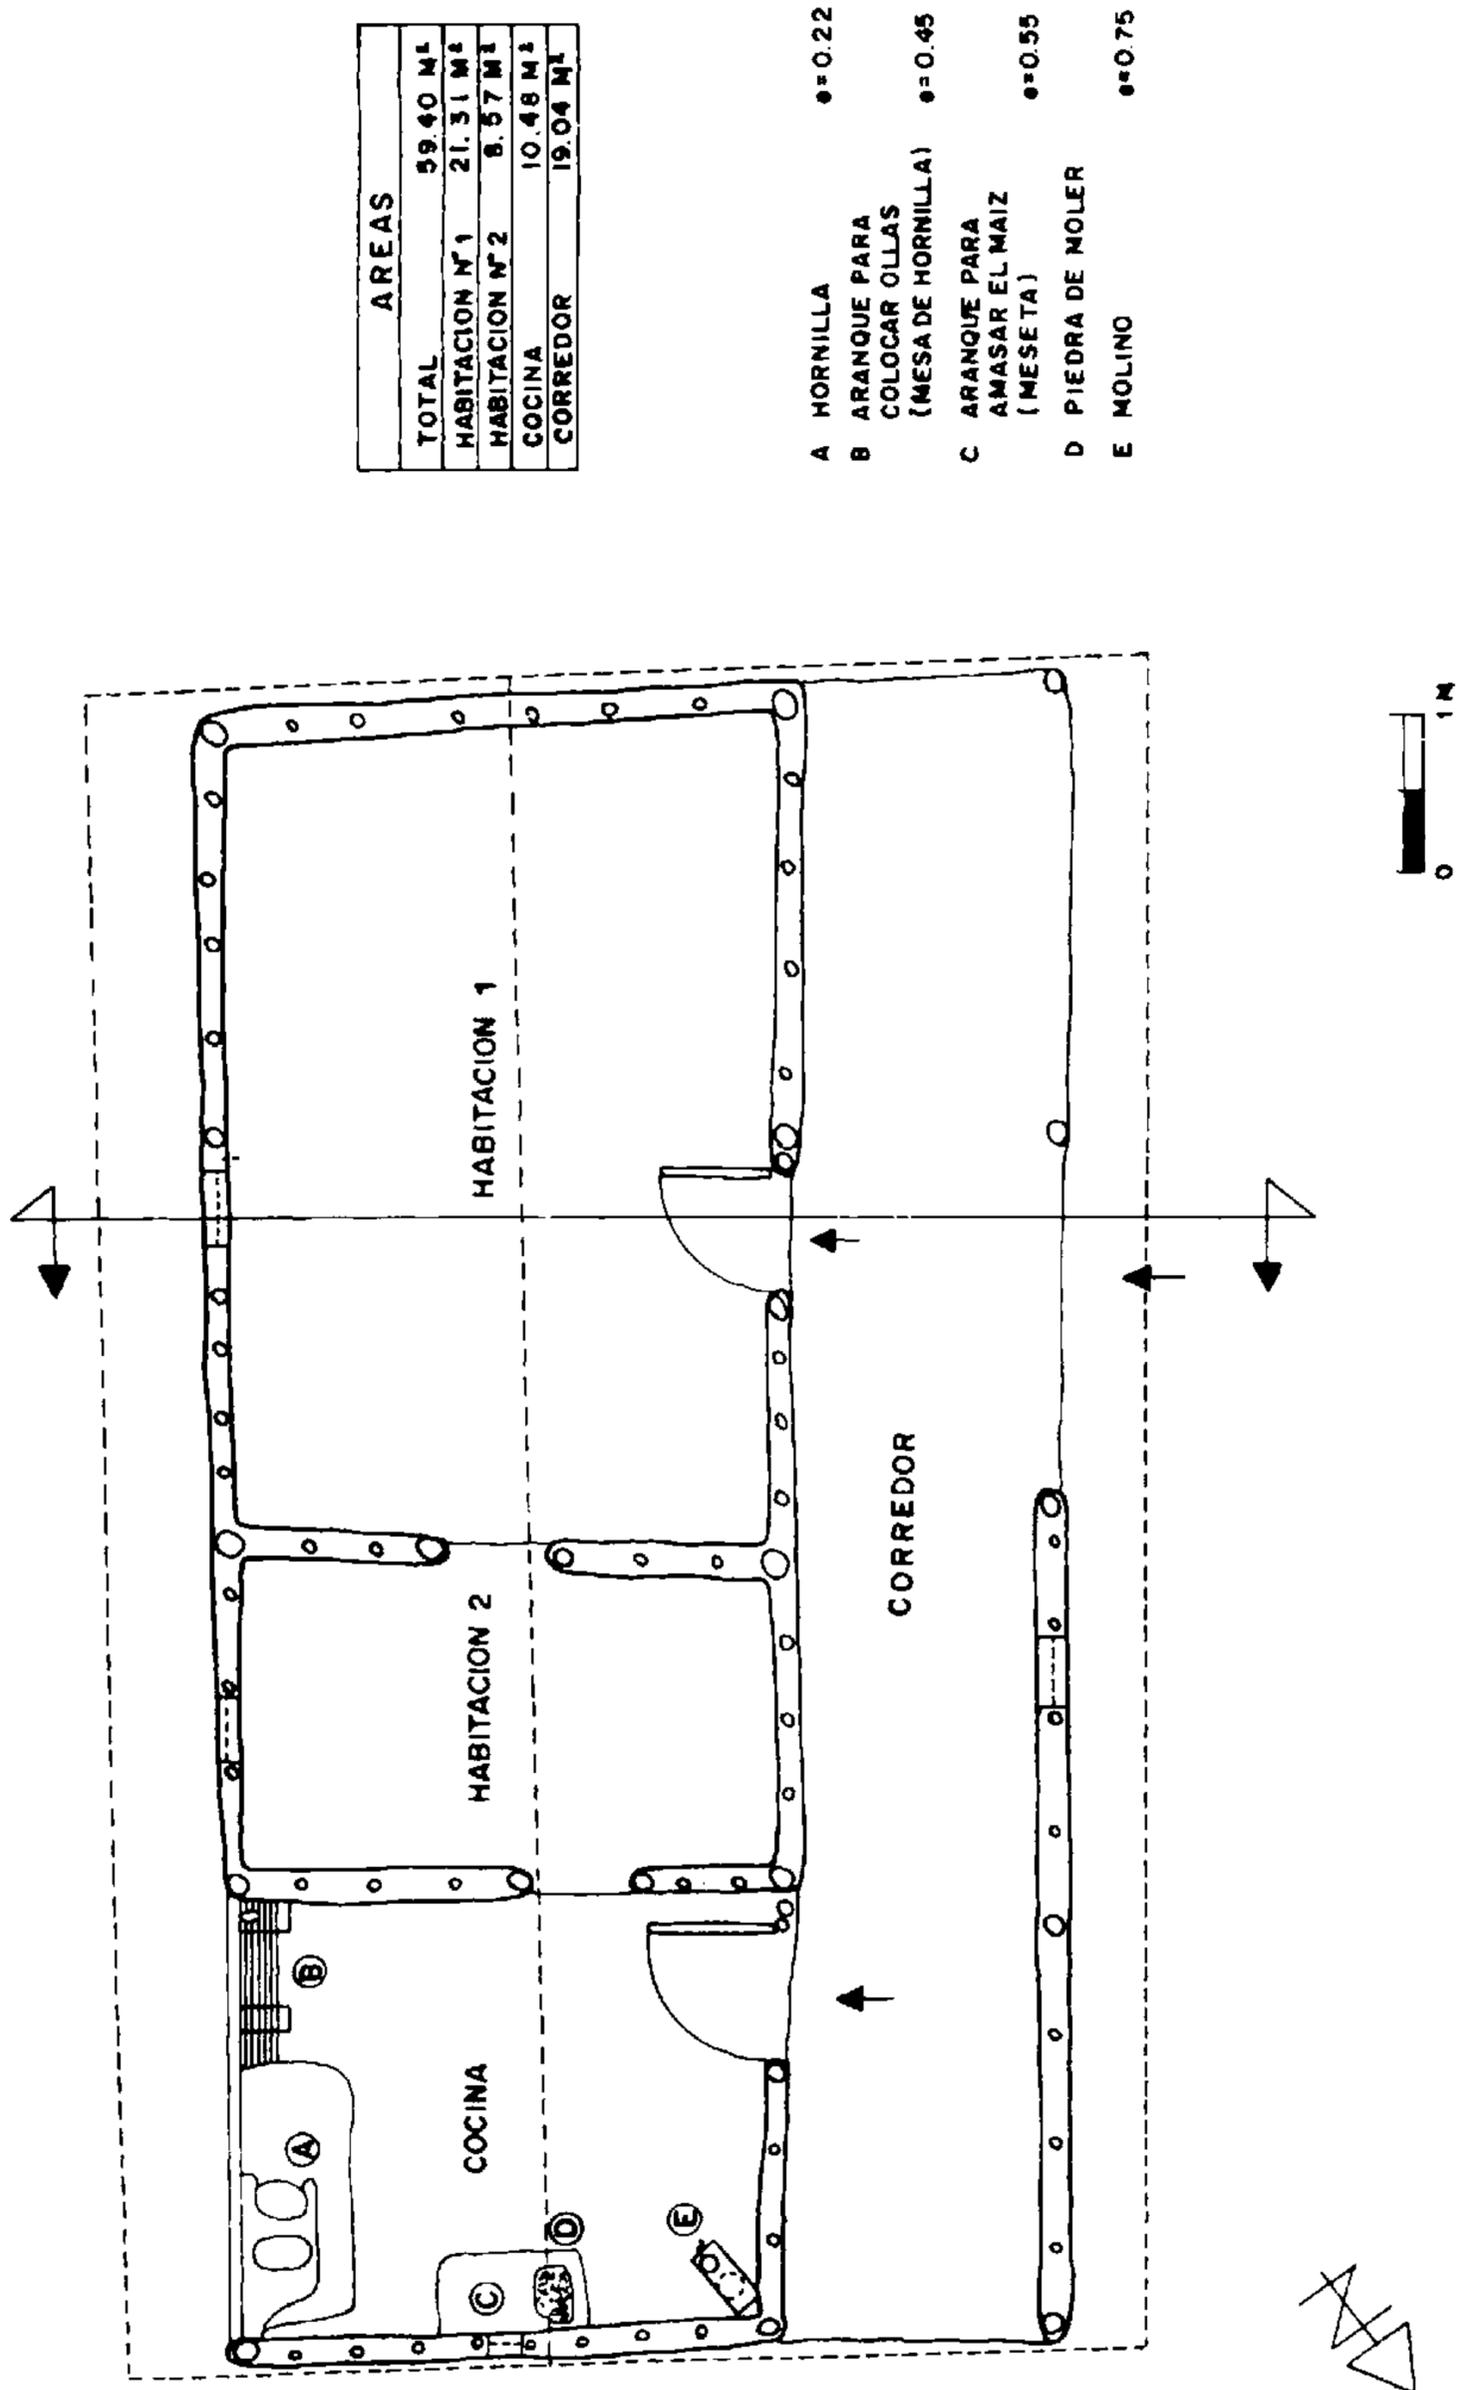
PLANTA DE LA CASA DE DON CALECHO
